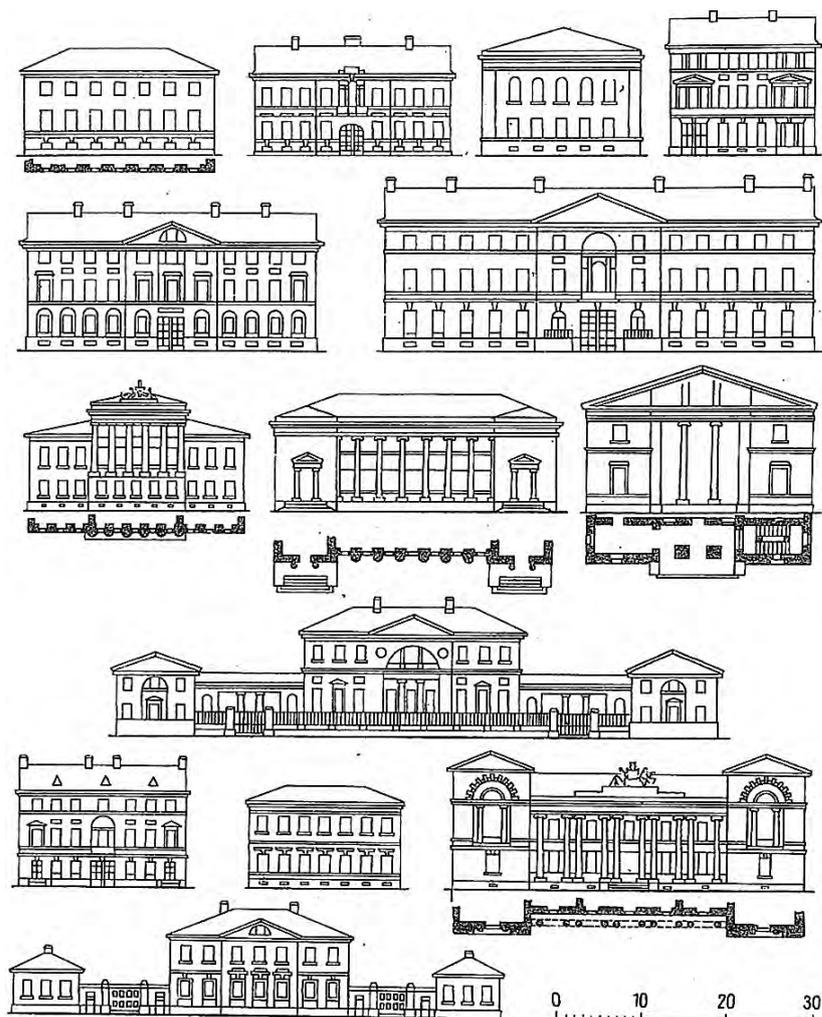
«Собрание фасадов». Фасады второго альбома 1809 г.
